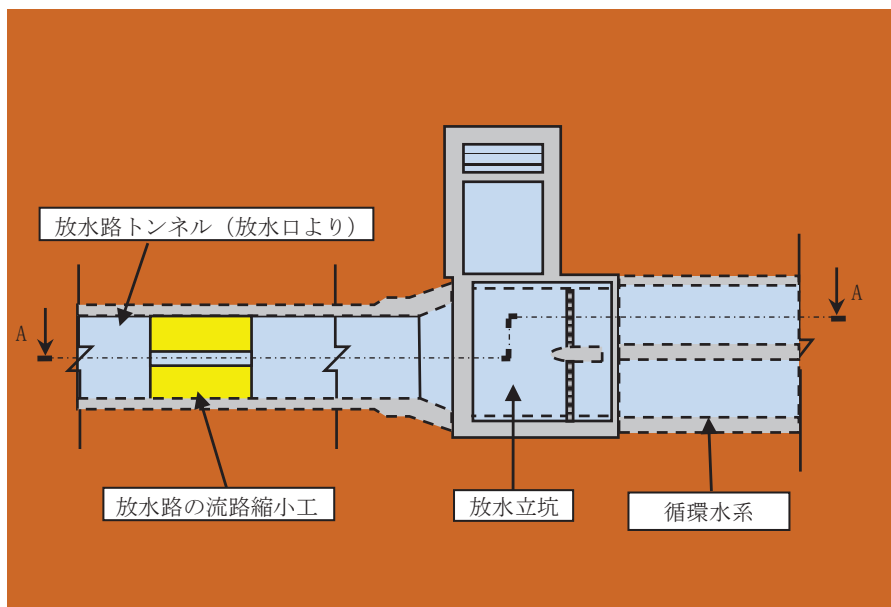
(13) 第 1 号機 放水立坑 流入対策配置図 (平面図)
